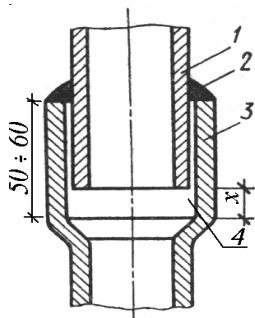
Компенсирующий раструб: 1 – гладкий конец газопровода; 2- сварной шов; 3 – раструб; 4 - компенсирующий зазор –  $x$
